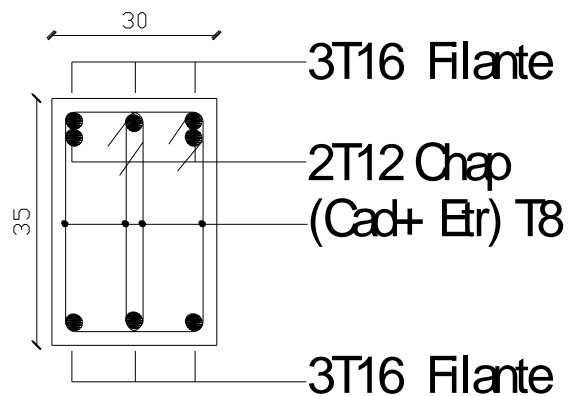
Ferrailage aux appuis d'une poutre secondaire
